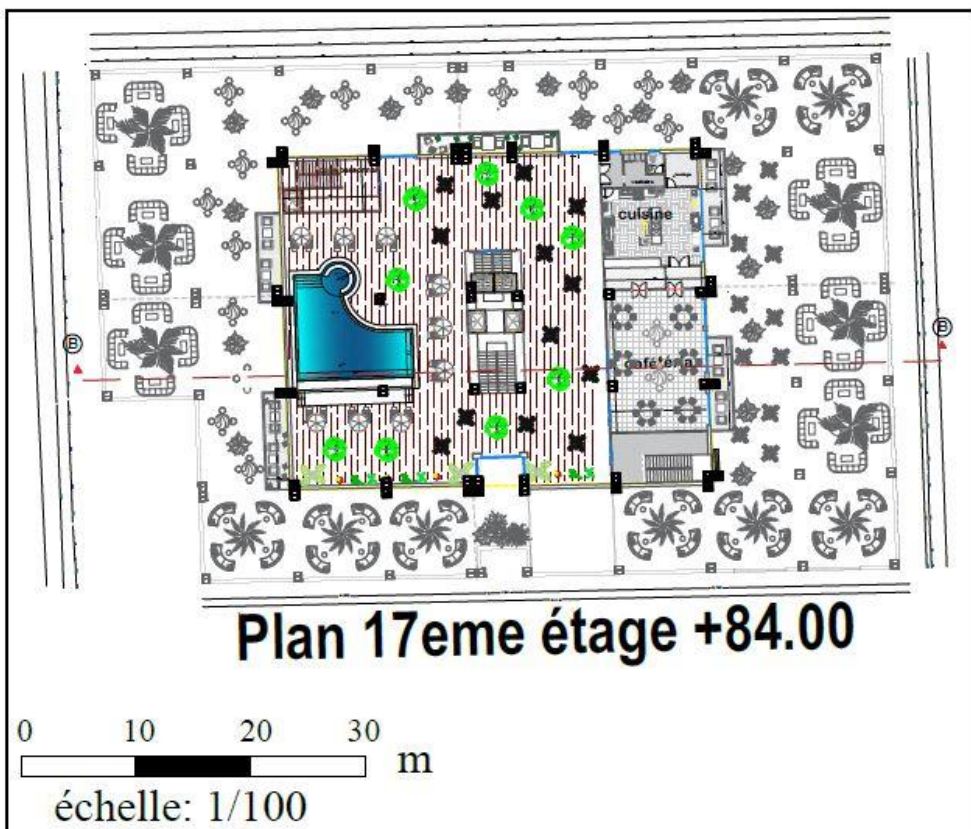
Plan de 17 Emme étages+84.00/Source : Traiter par l'auteur.
